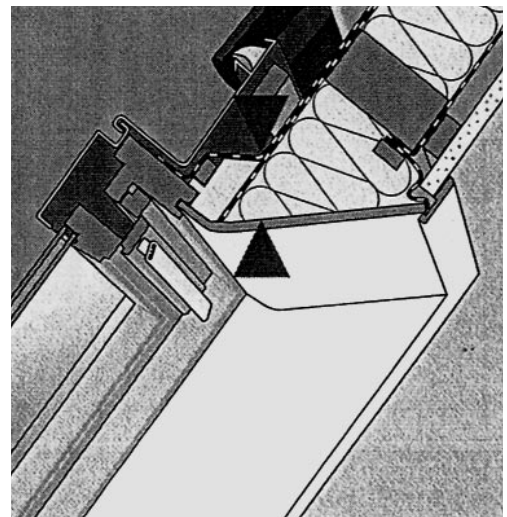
Das vorgefertigte Innenfutter des Dachflächenfensters ermöglicht eine luftdichte Konstruktion.
